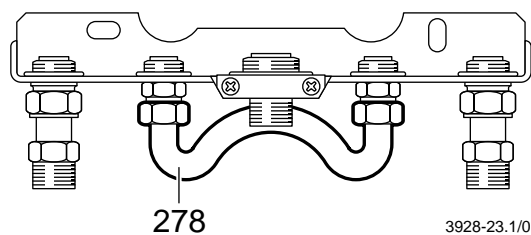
Montażowa płyta przyłączeniowa - zamontowana
